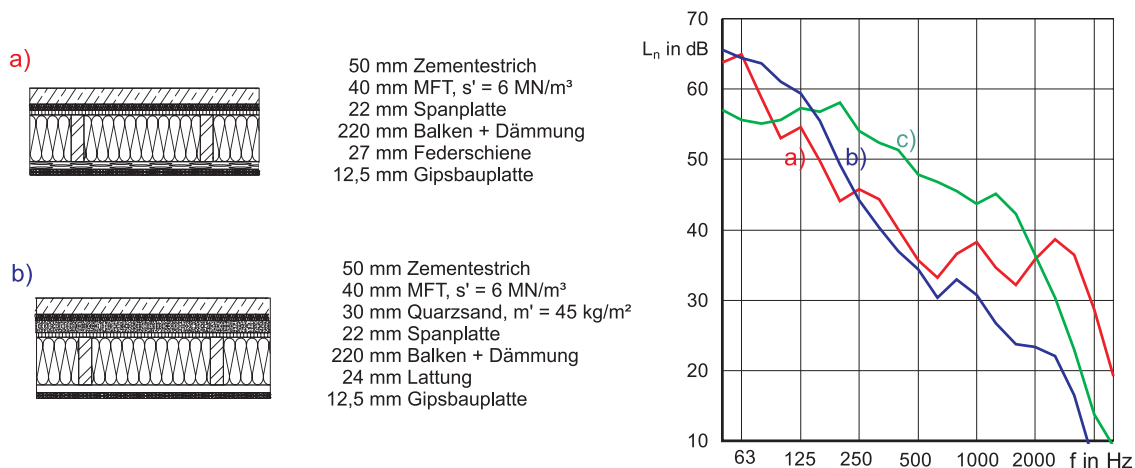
Messwerte der optimierten Holzbalkendecke im Vergleich zu konventionellen Holzbalkendecken: a) Holzbalkendecke mit Unterdecke an Federschiene b) Holzbalkendecke mit Rohdeckenbeschwerung c) optimierte Holzbalkendecke nach Abb. 5.12
